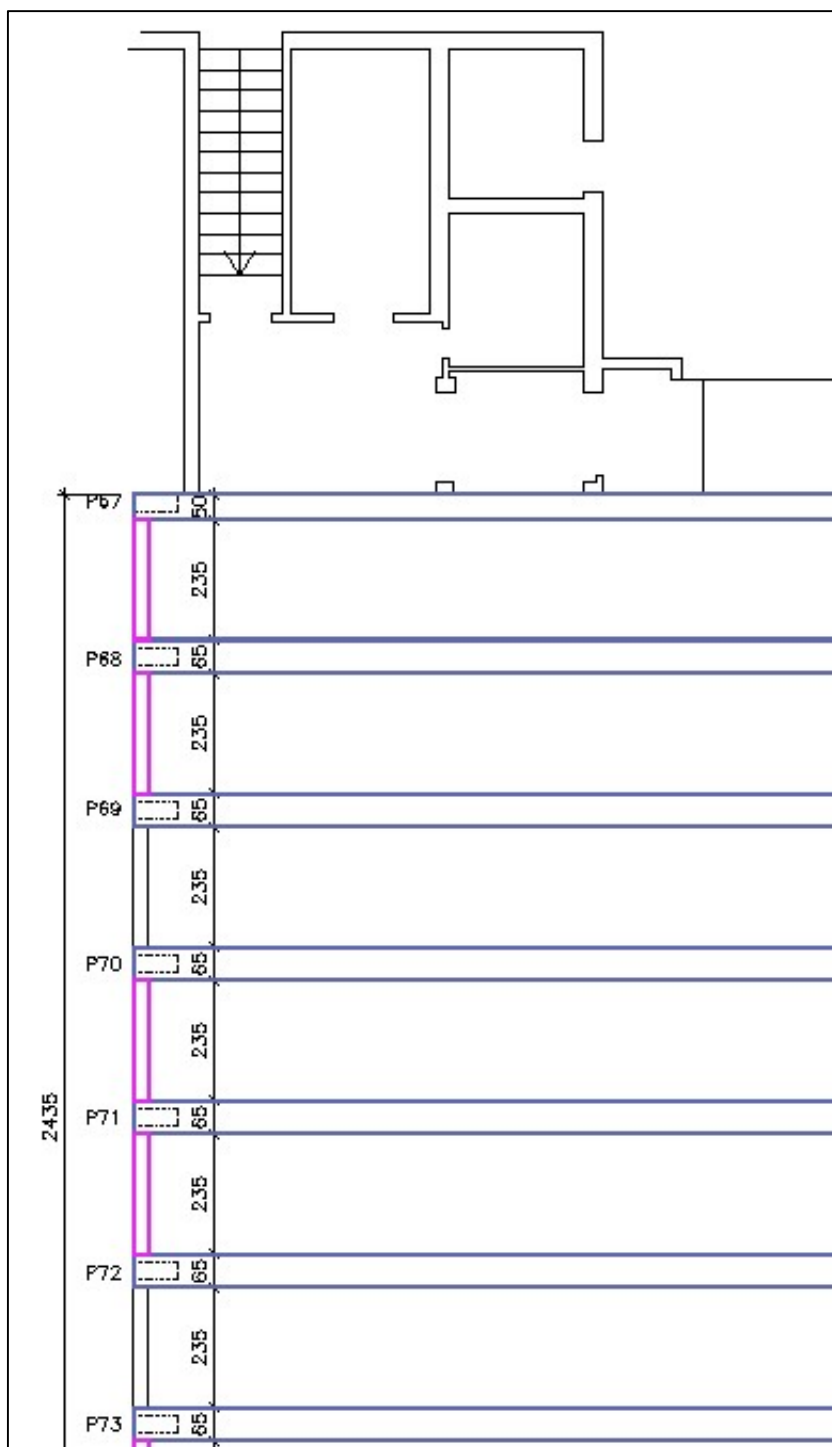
Planimetria copertura della palestra – stato di progetto (studio di fattibilità)
